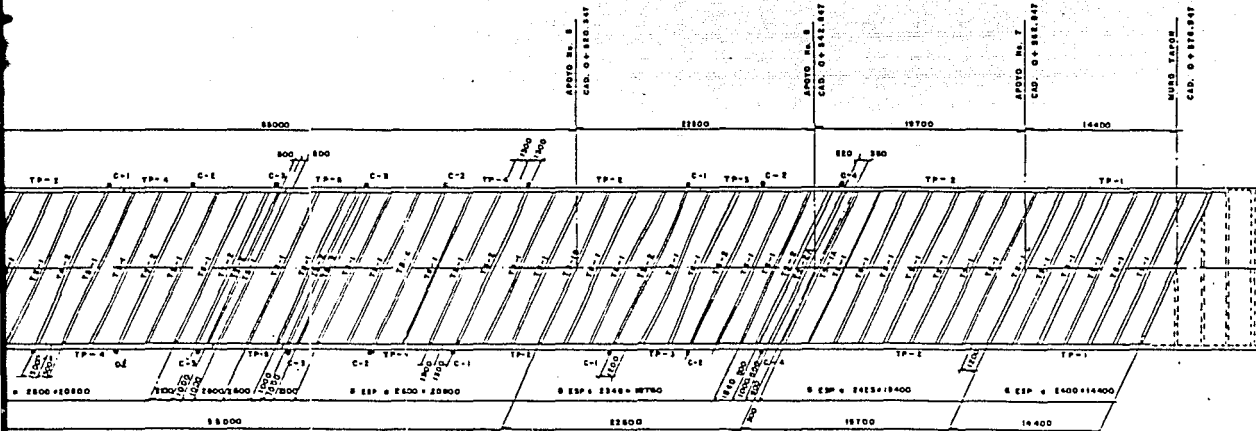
PLANTA DEL PUENTE, TRABES DE ACERO PRINCIPALES Y SECUNDARIAS.
